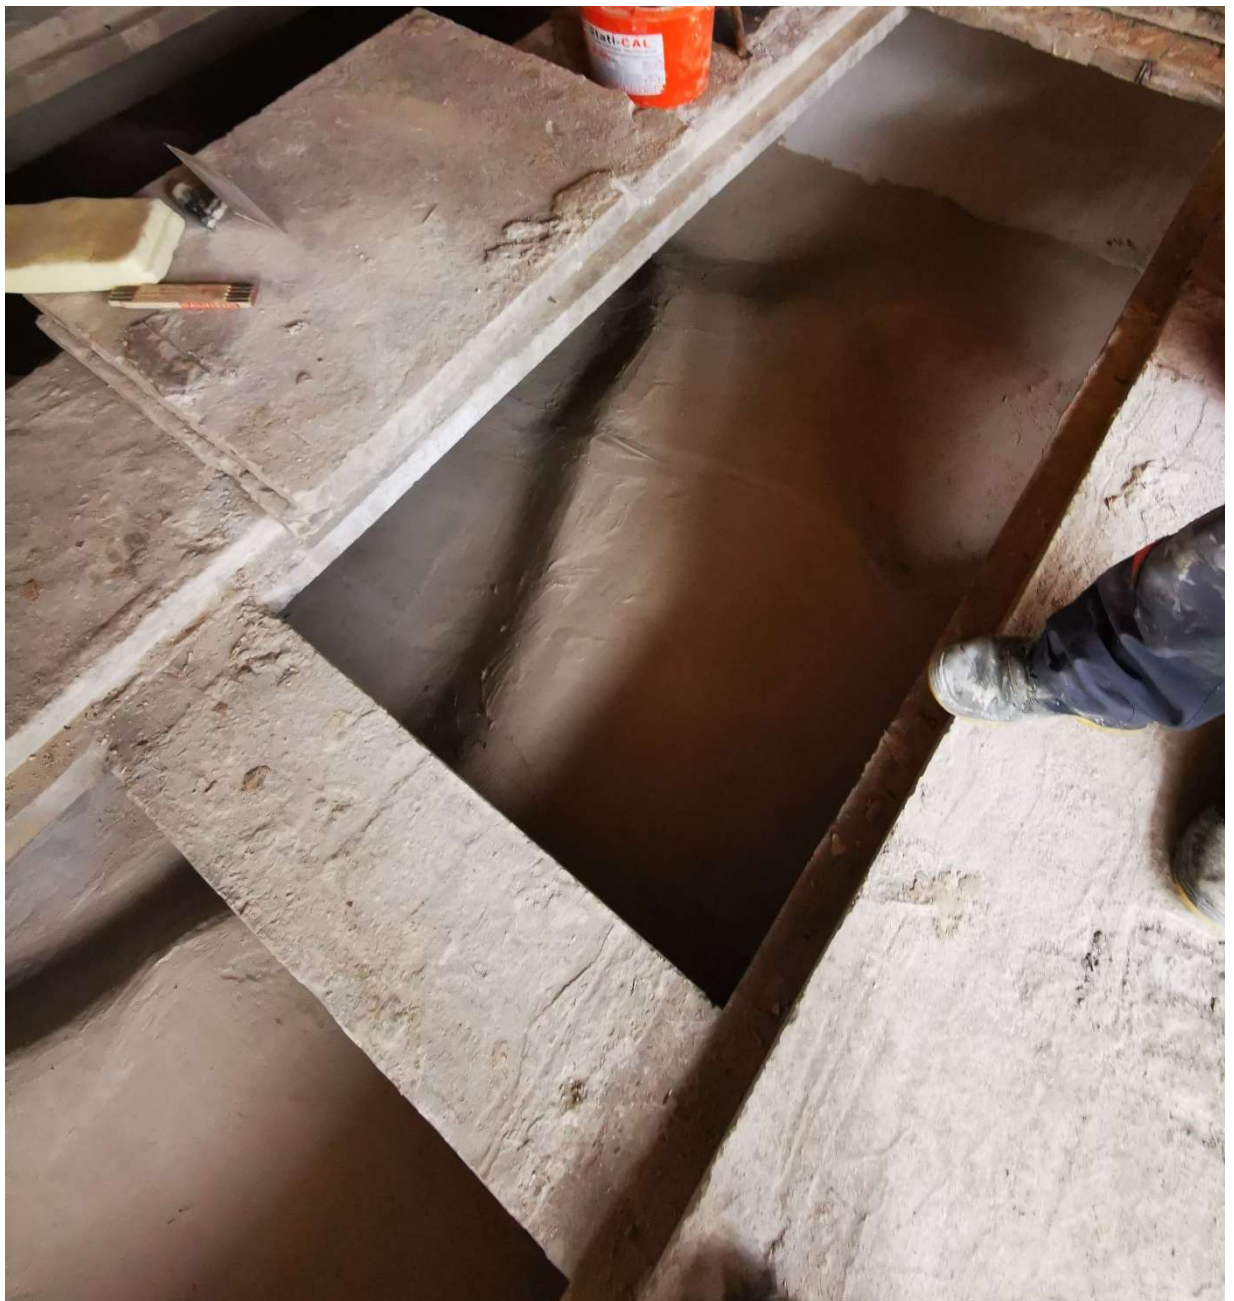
Sklepienie widoczne po usunięciu betonowych płyt stropowych – miejsce łączenia się odbudowanego sklepienia powojennego z przedwojennym (fot. W. Domagała)
